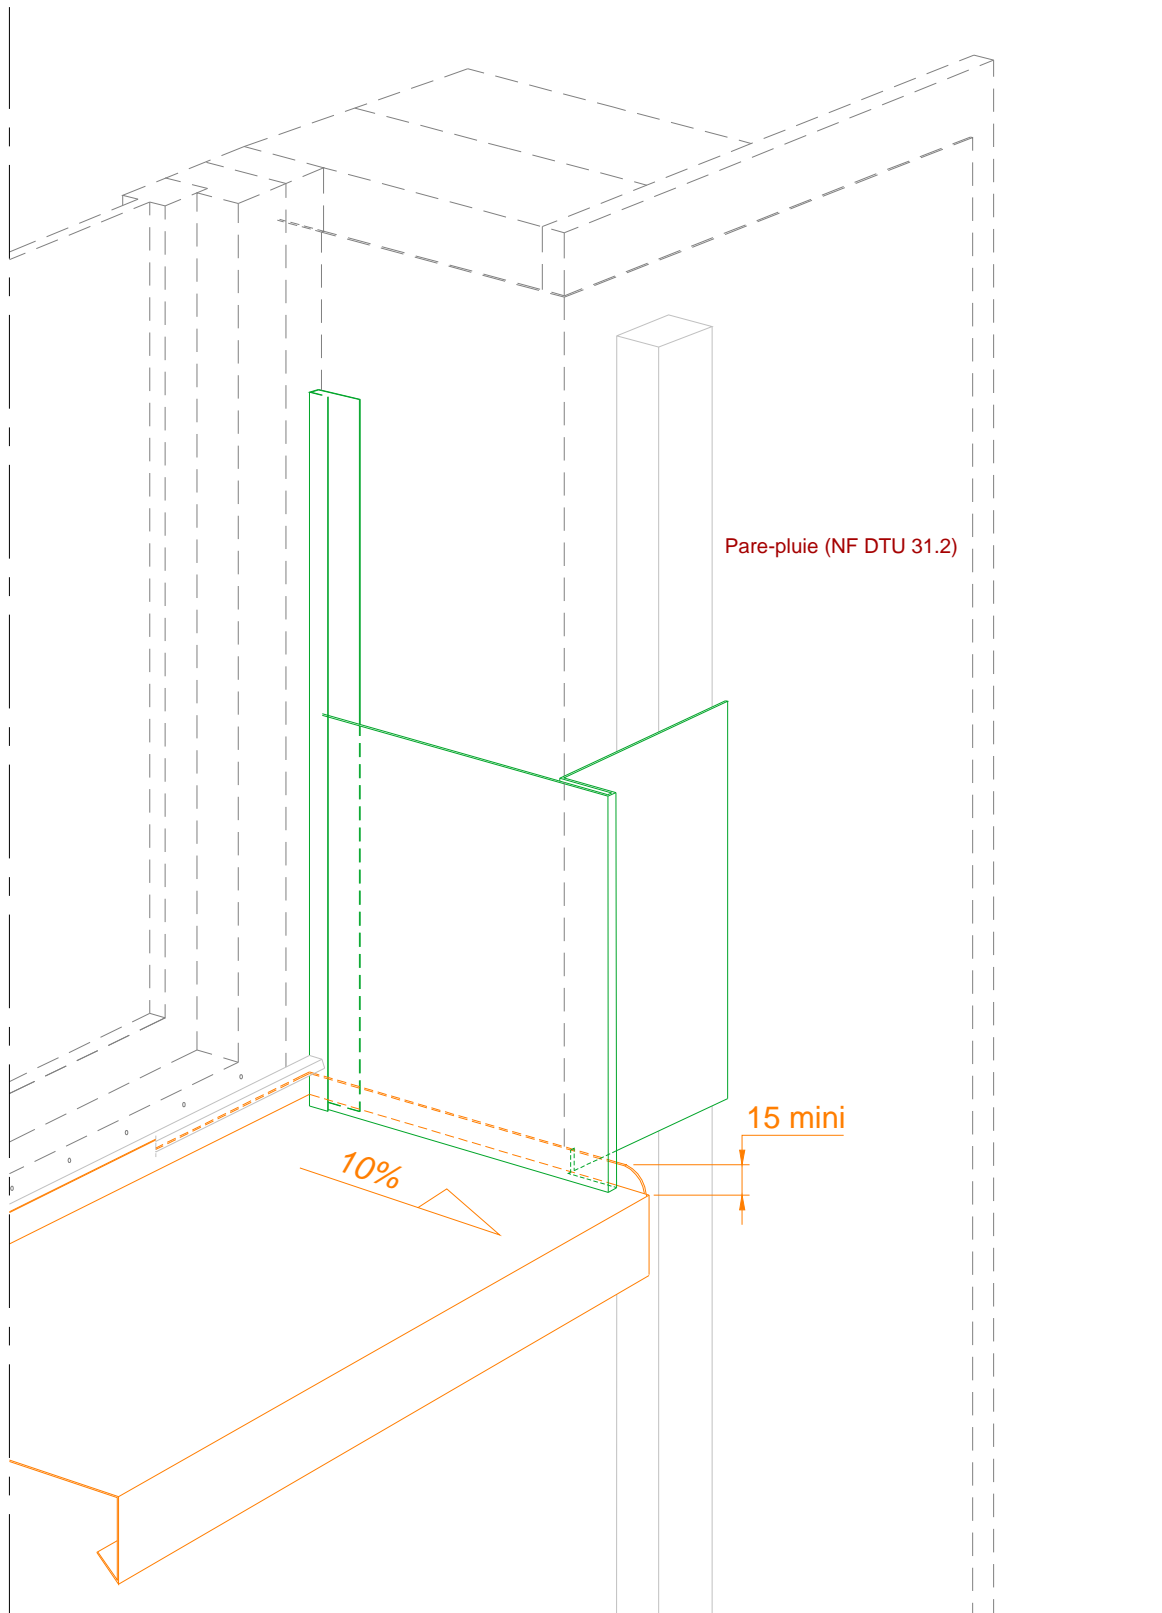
Pose sur COB – Coupe sur appui de baie
